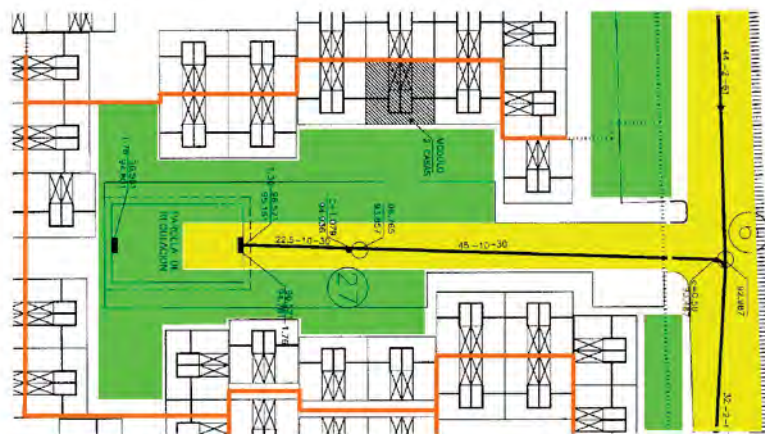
PLANTA DE UN CLAUSTRO TIPO DE VIVIENDAS indicando la ubicación de su parcela de regulación e infiltración
